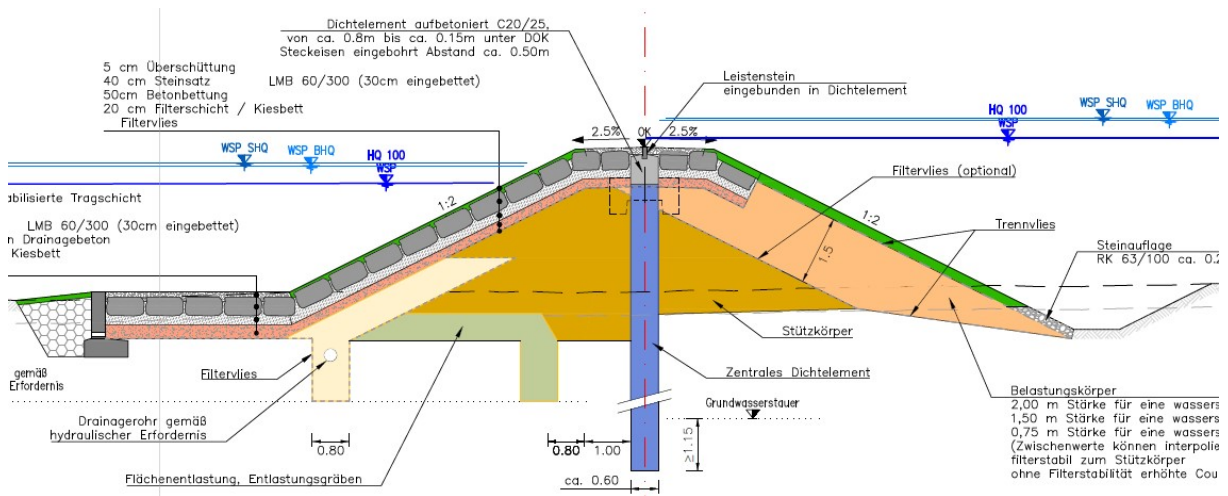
Überströmstrecke im Querdamm zwischen Becken 1 und Becken 2 ([17], Beilage 8)
